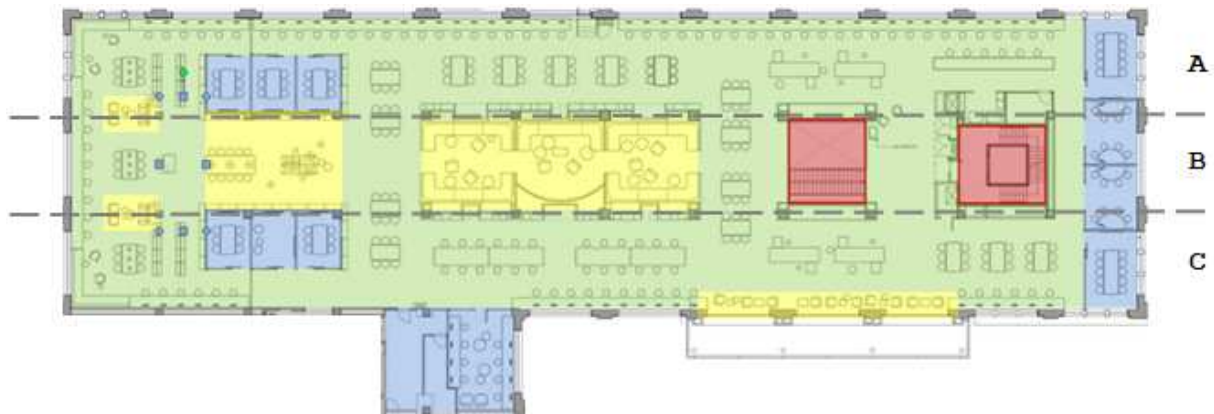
Planta baixa do segundo pavimento da Biblioteca Raheen.
